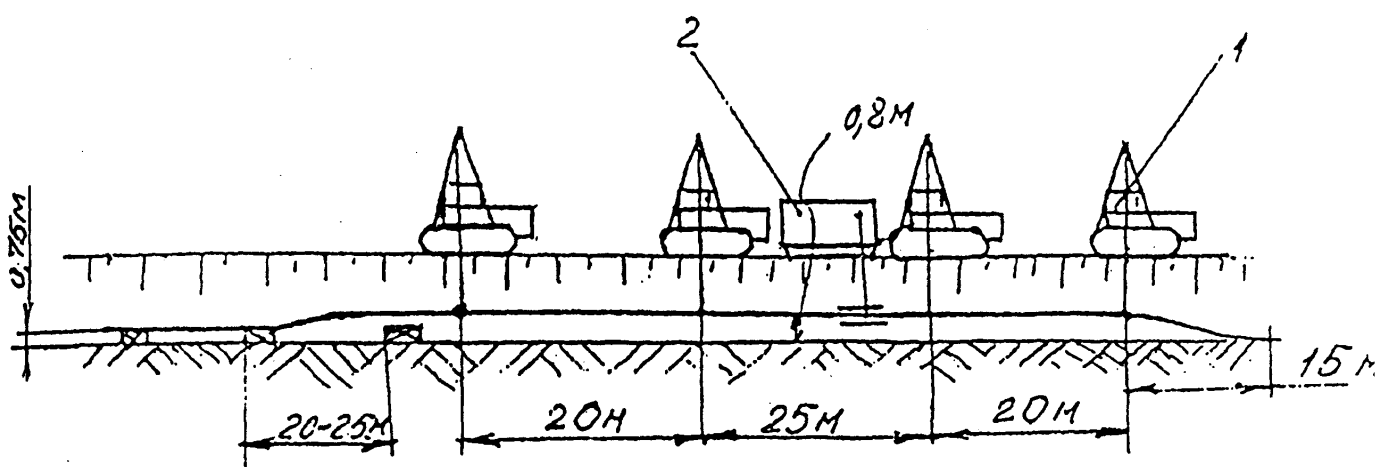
Підйом трубопроводу в траншеї з укладкою на ліжки і з видаленням старої ізоляції
